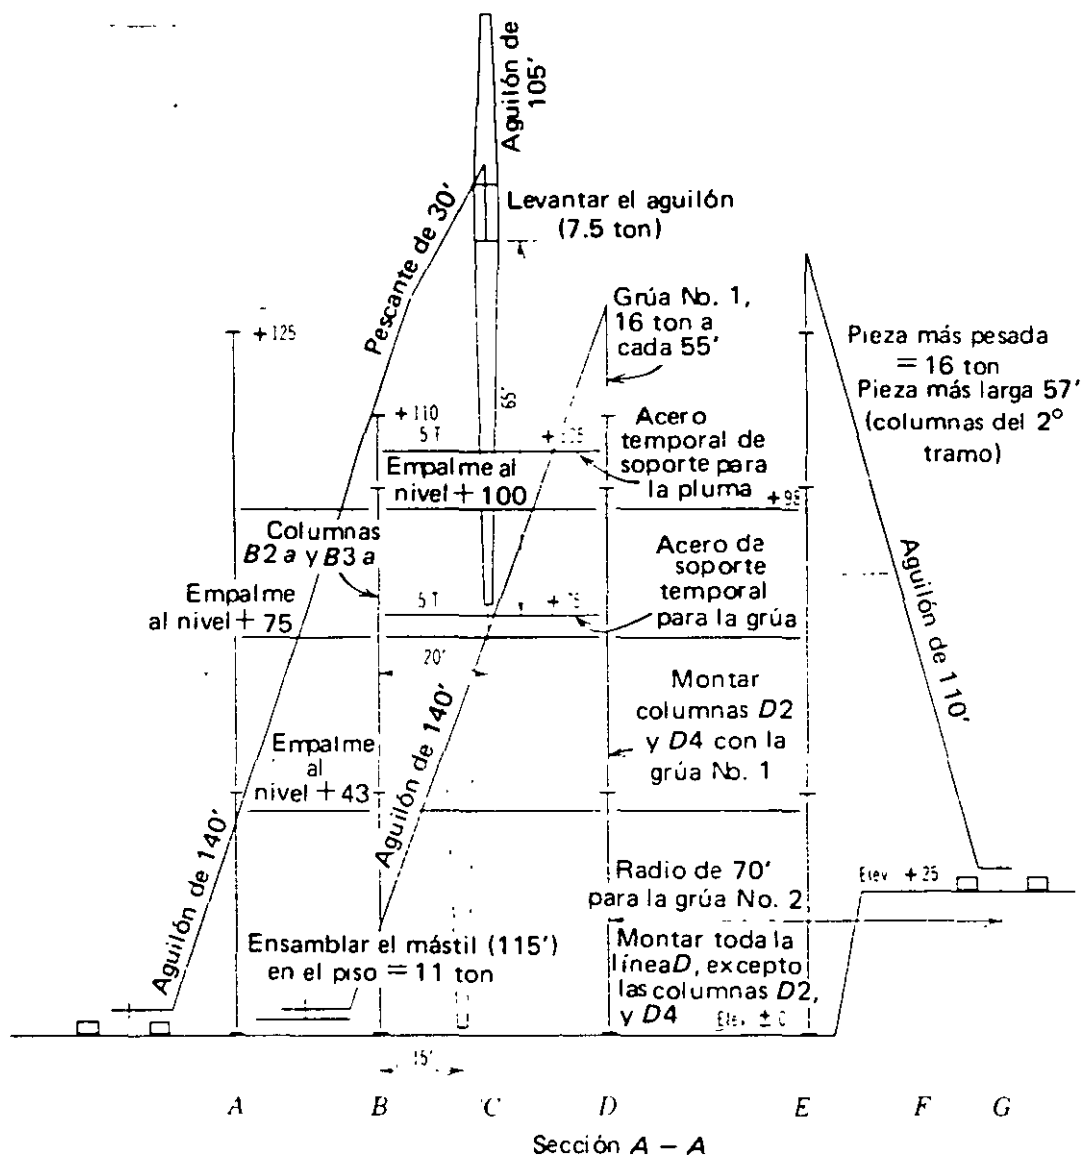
Dibujo del plan de montaje – Hoja 2. Trabájese esta hoja con la hoja 1.
